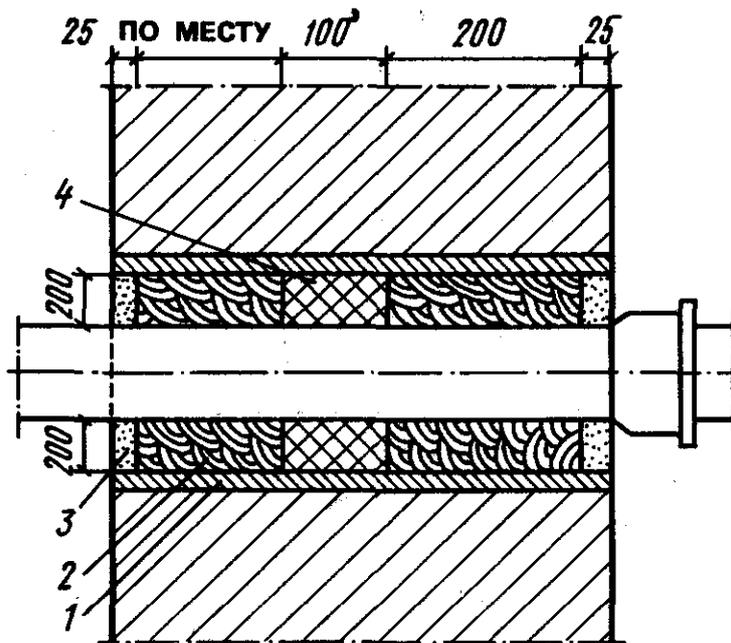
Увід водопроводу через стіну підвалу у сухих ґрунтах:
